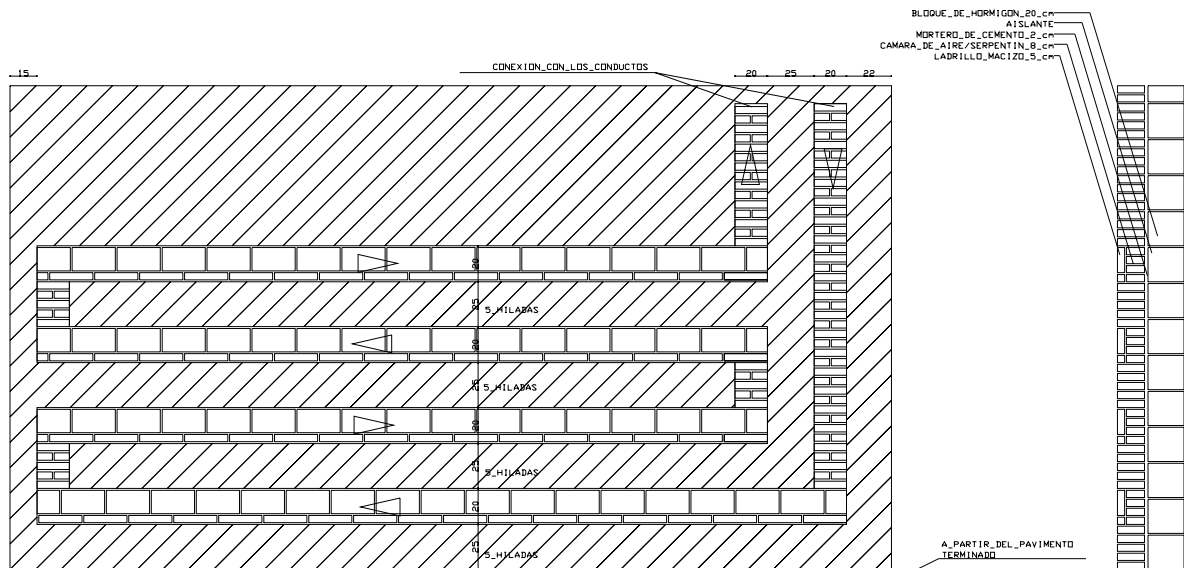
Muro de almacenamiento de calor de pared Norte (Muro serpentín).
